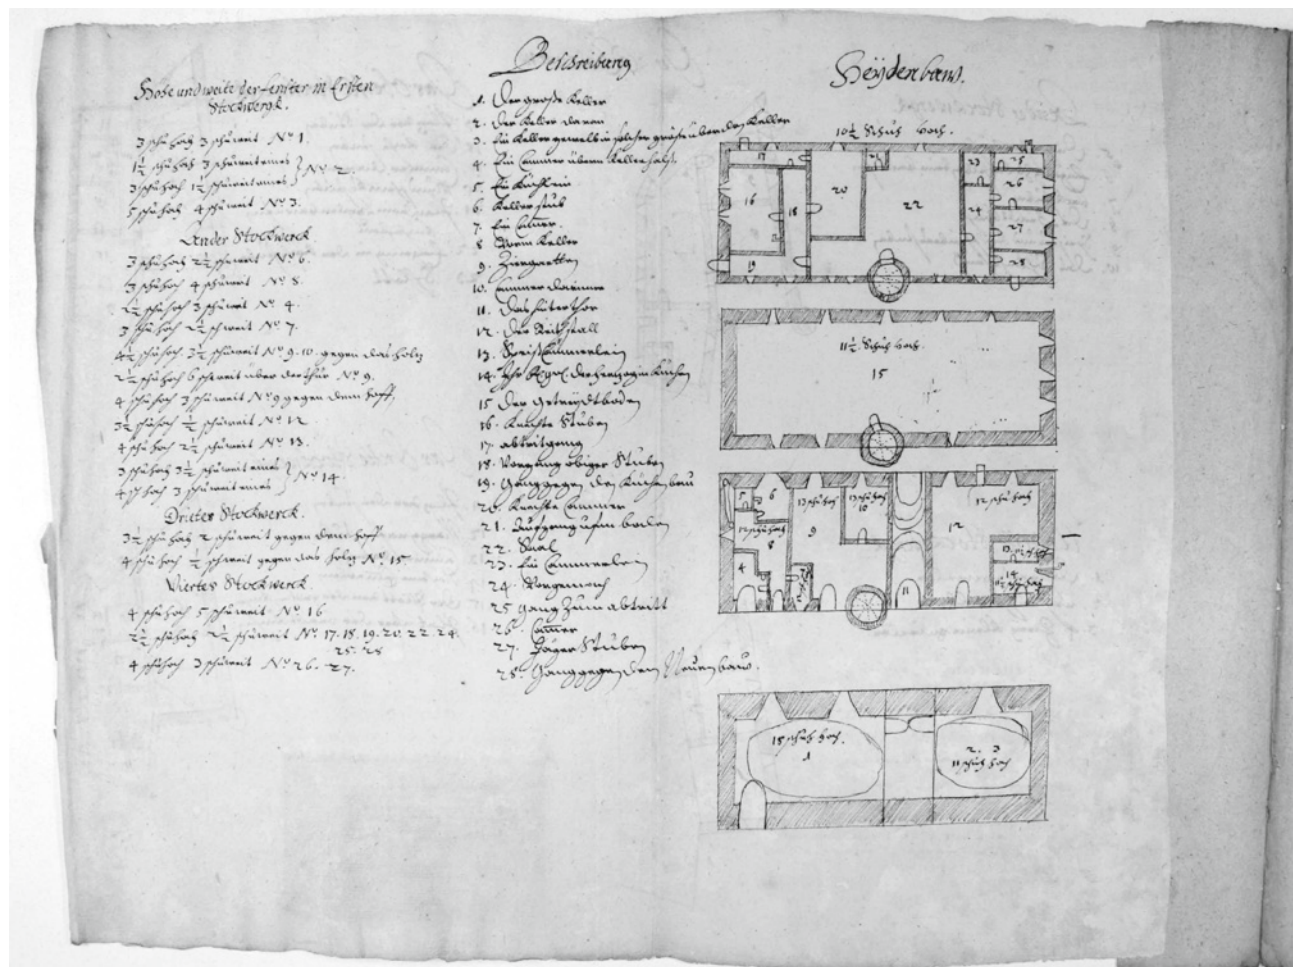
Plan des Heidenbaues in einem Inventar von Wilhelmi 1667, Staatsarchiv Coburg, Plansammlung Veste Heldburg, Plan 1149 li
